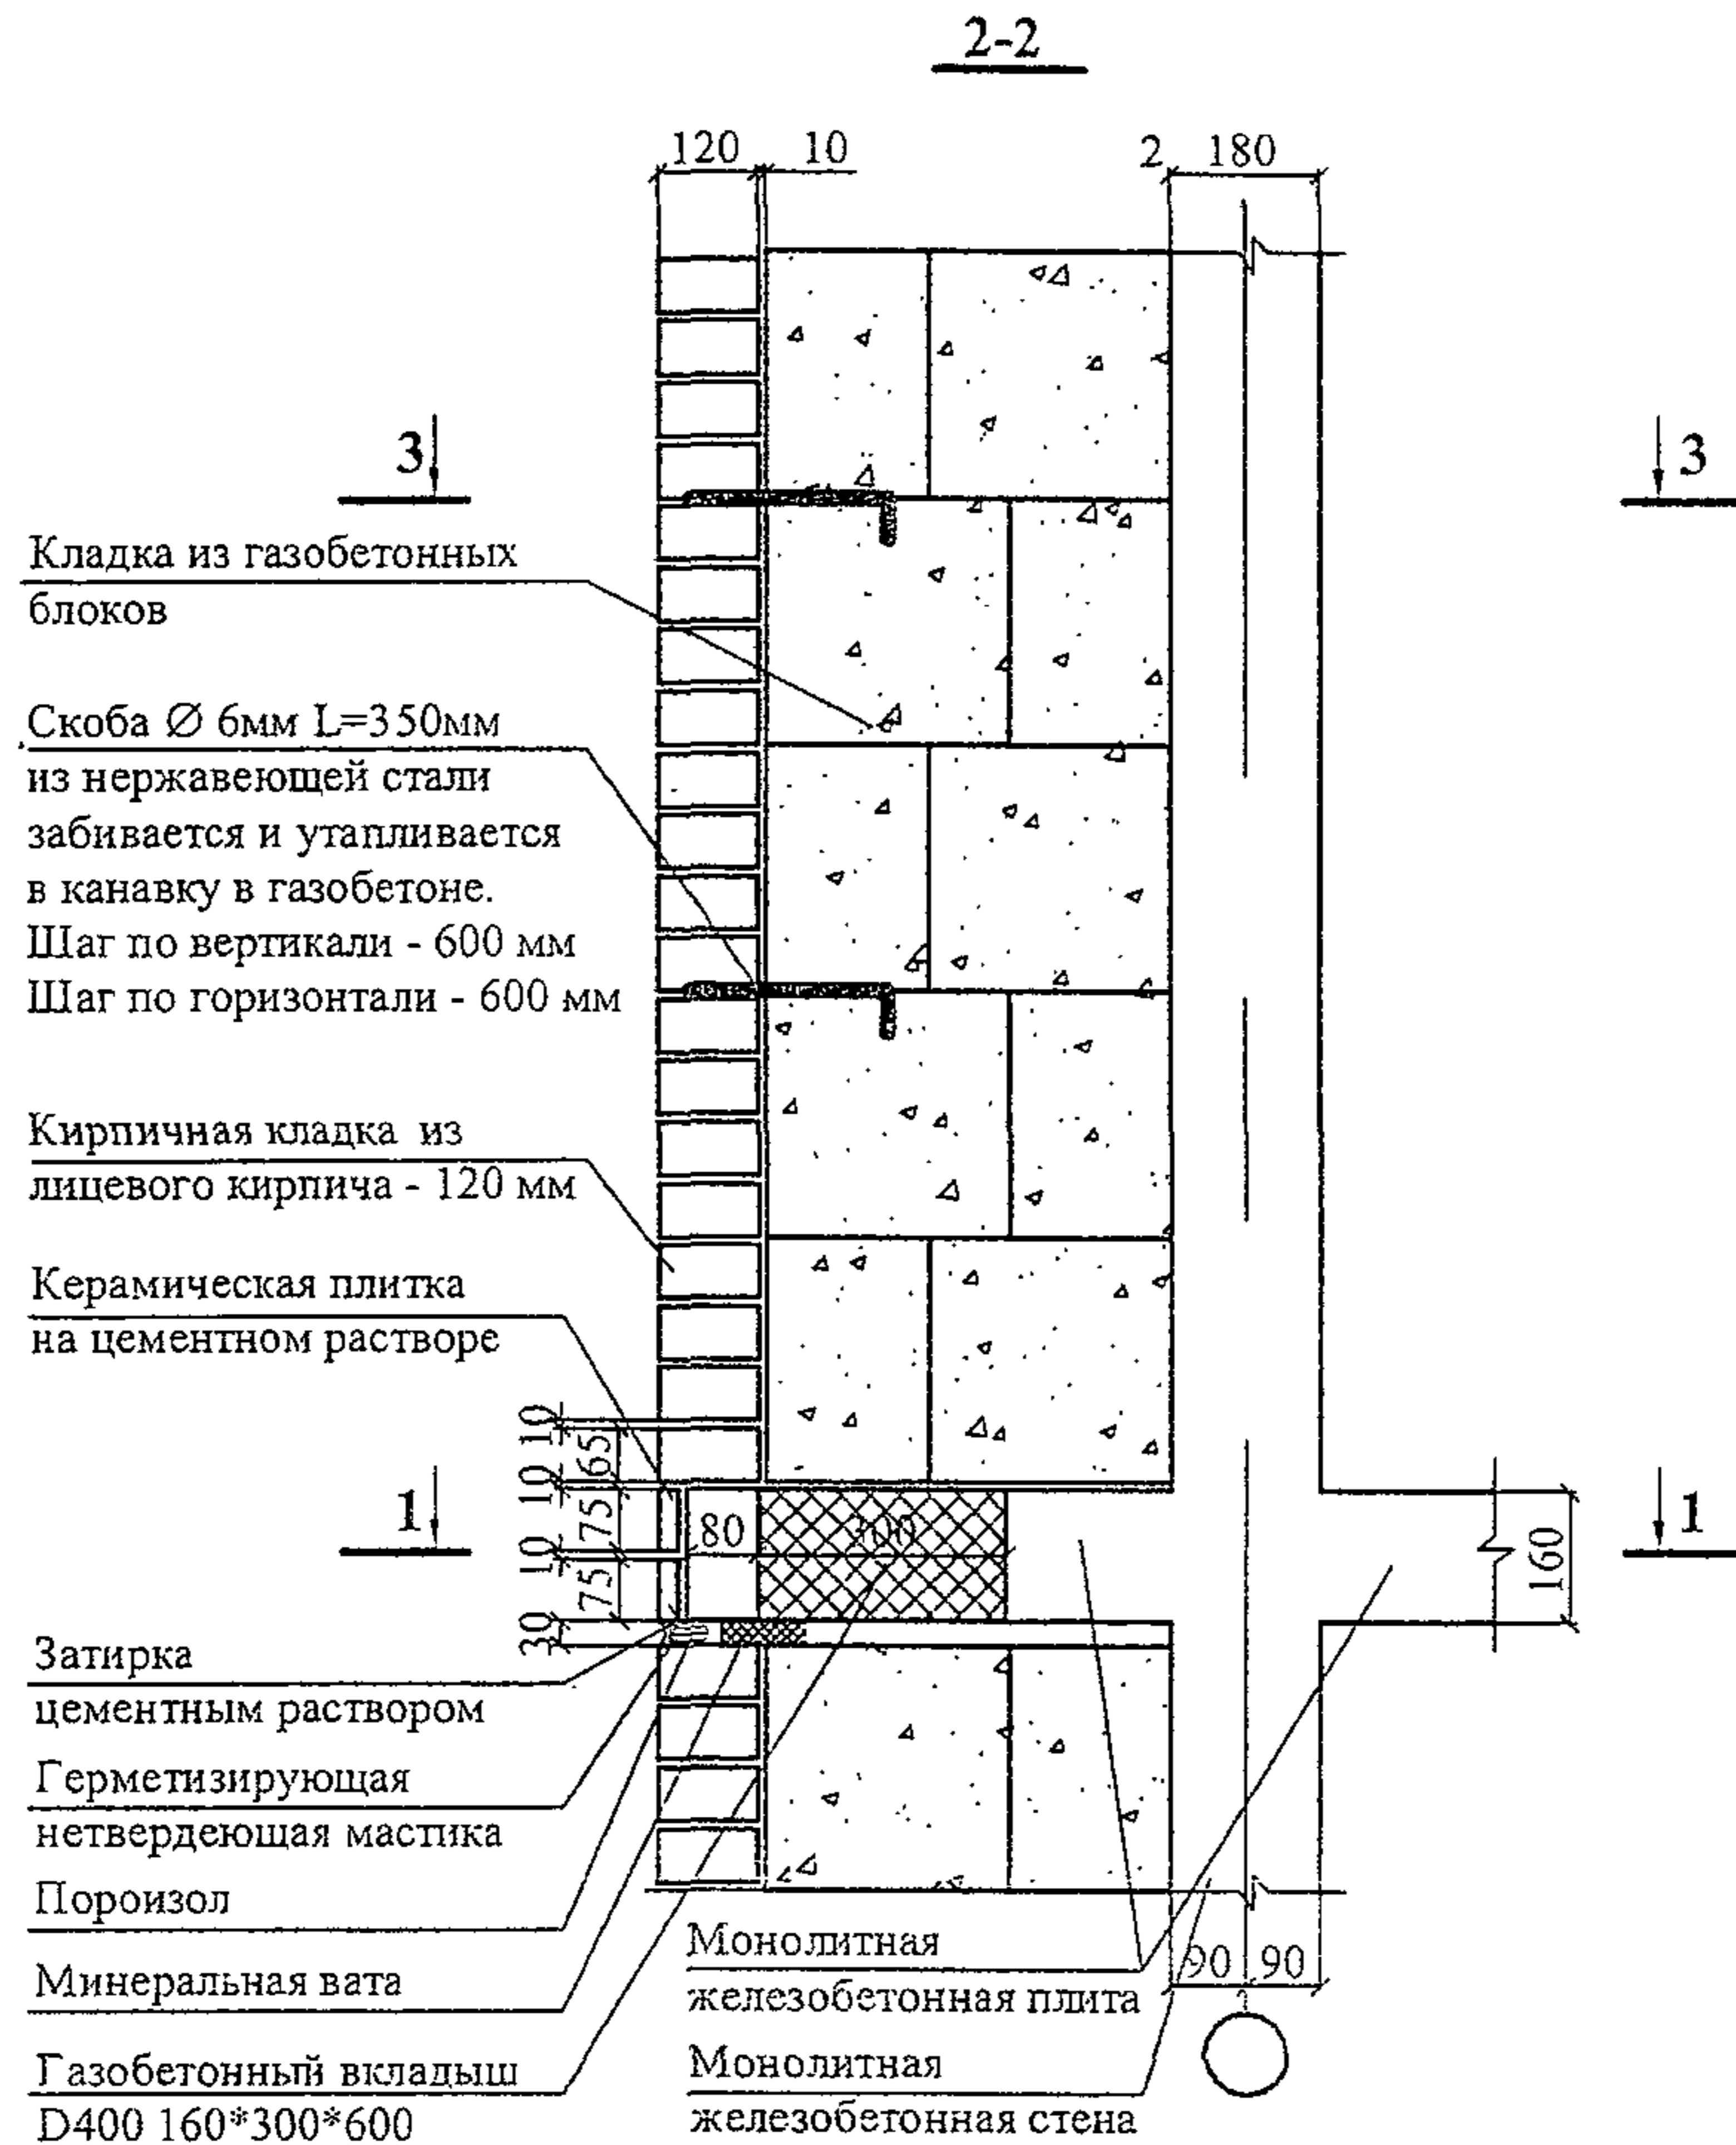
Несущая наружная стена из монолитного бетона и кирпича с газобетонными блоками на клею
